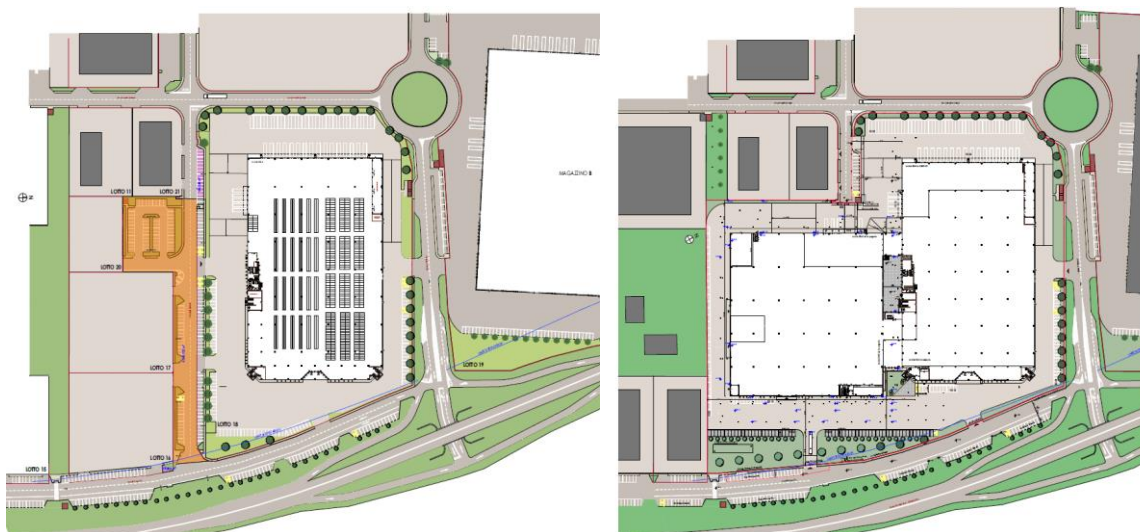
Planimetria di stato di fatto e di progetto a confronto
